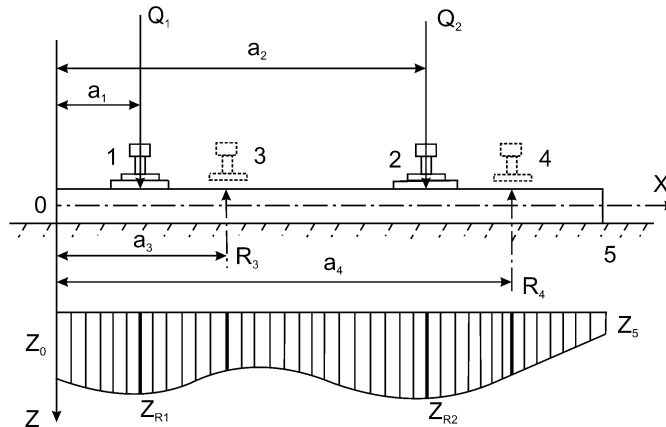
Розрахункова схема роботи шпали, як балки на пружній основі
